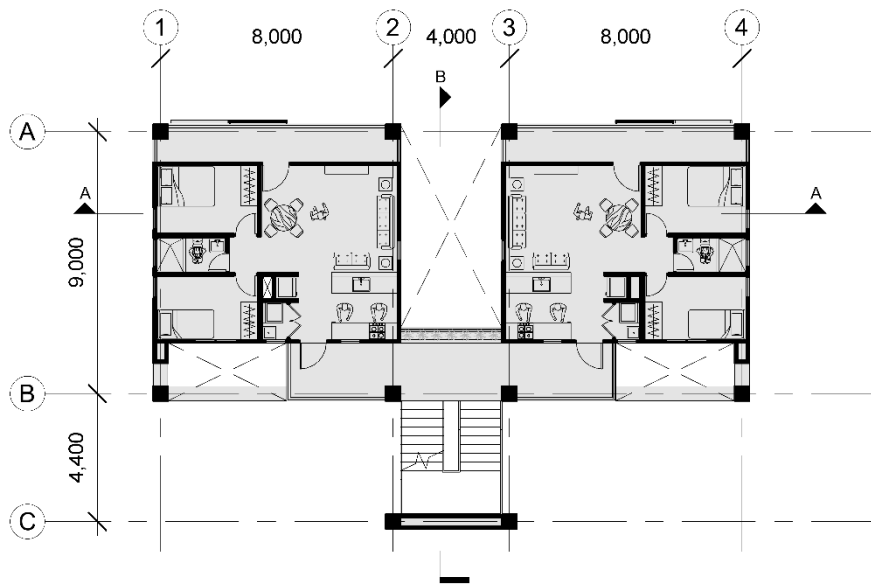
PLANTA ARQUITECTÓNICA EDIFICIO 1 | Elaborado por: El autor
